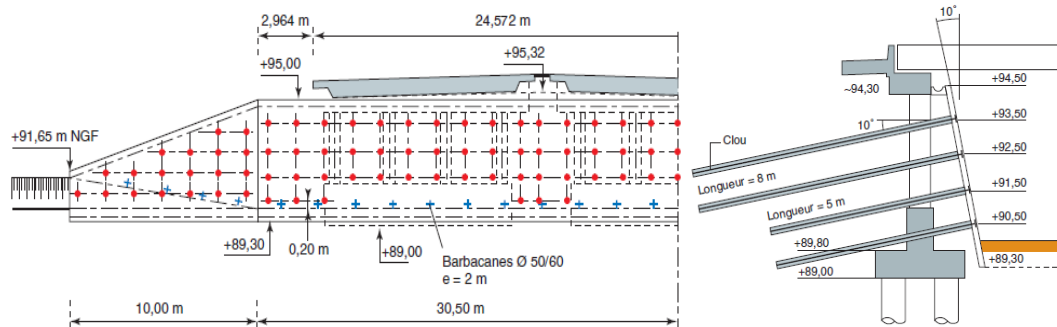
Exemple de disruption des clous (élévation et coupe transversale) d'une culée d'un ouvrage d'art
